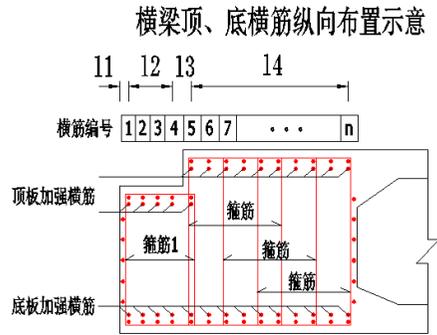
端横梁-横梁钢筋立面示意图
